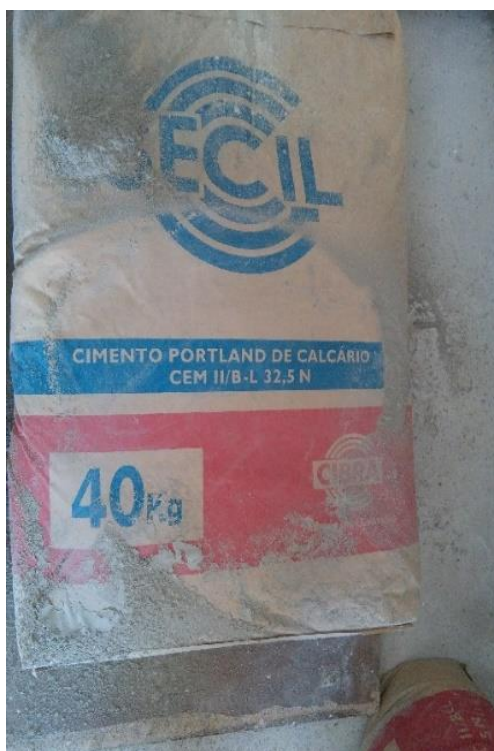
Exemplo do tipo de cimento utilizado para argamassa de cimento nos pavimentos
